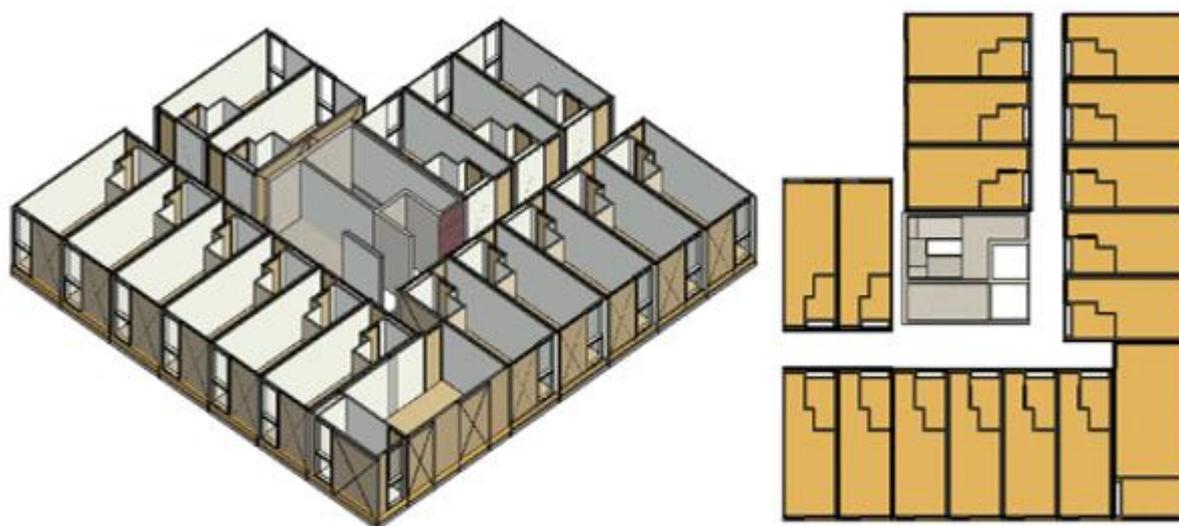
Módulos colocados local de obra (à esquerda) e vista em planta (à direita)
